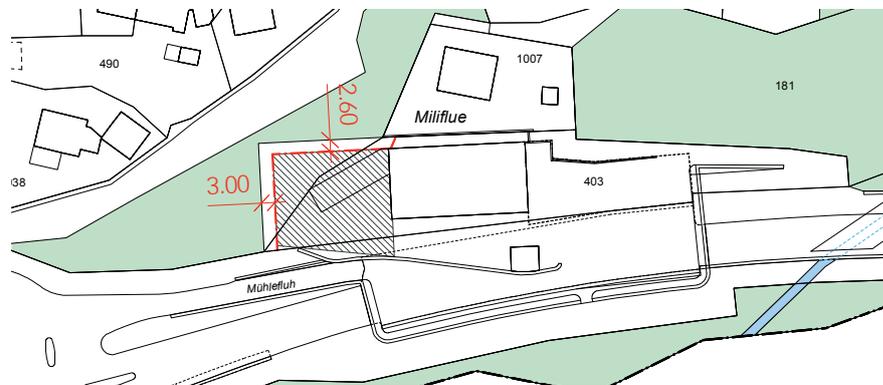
Durch die Waldbaulinie definierter Waldabstand (rot); schwarz schraffiert: die geplante Werkstatthalle
